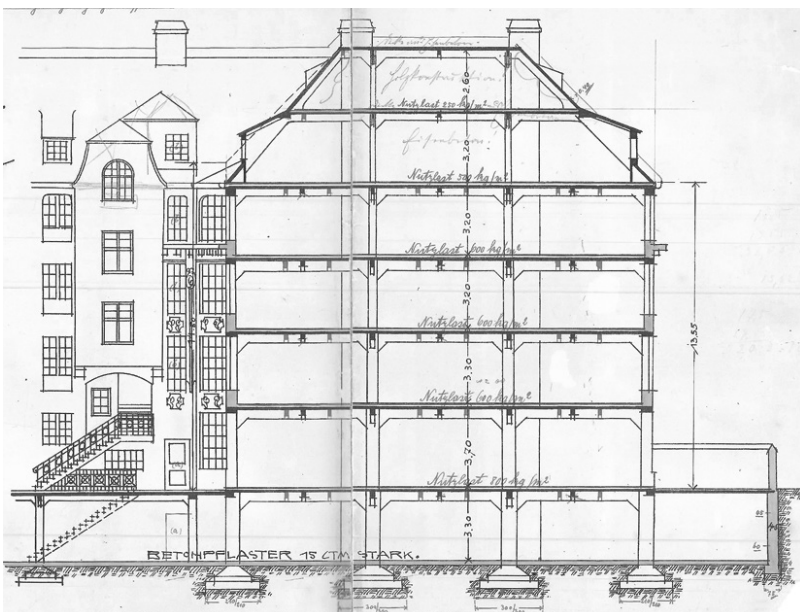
Augustenstr. 54, Längsschnitt Rückgebäude, 1907, Bauvorlageplan (LBK, Akt-Nr. 05716).
